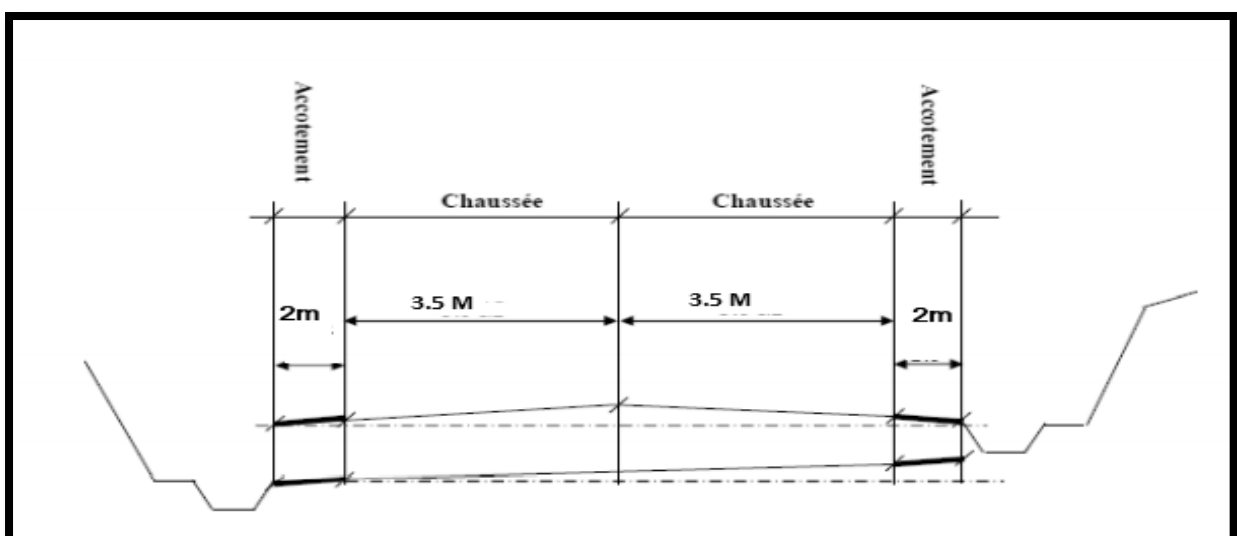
Schéma explicatif d'une coupe transversale de la chaussée prévue
